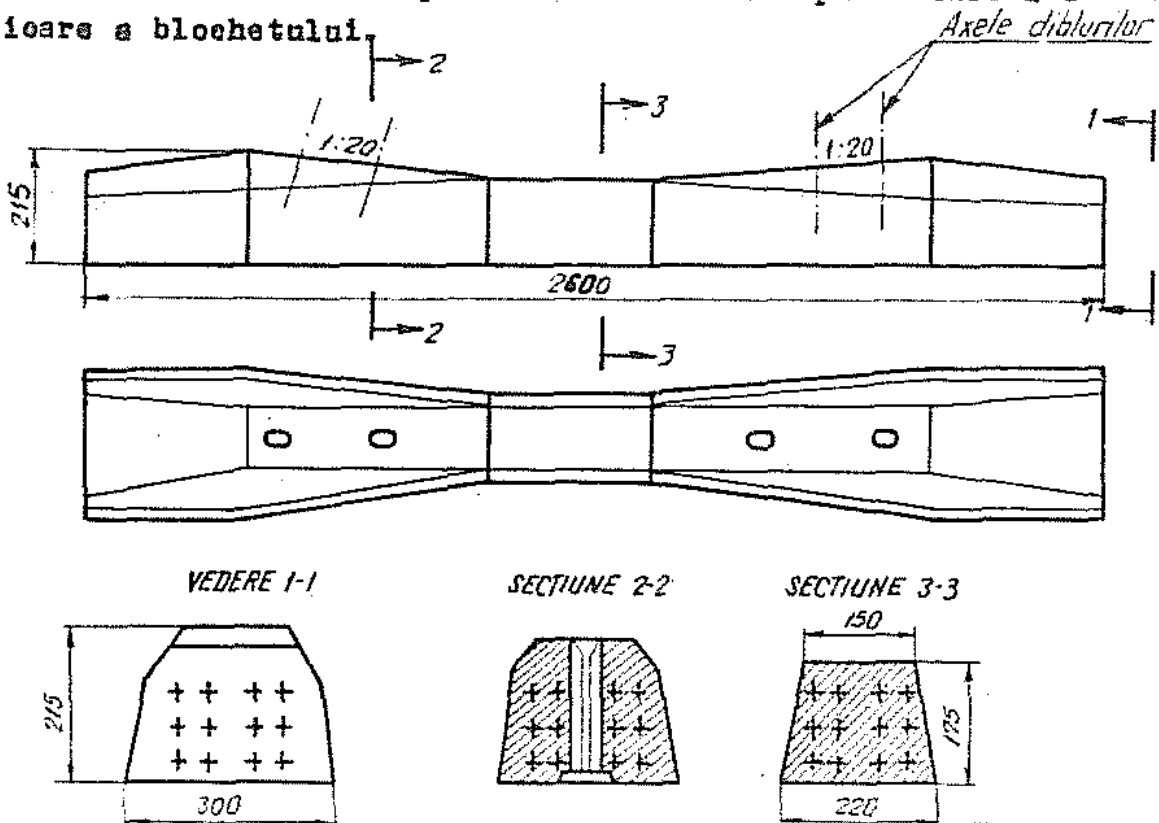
Traversa de beton armat precomprimat T₁₆
